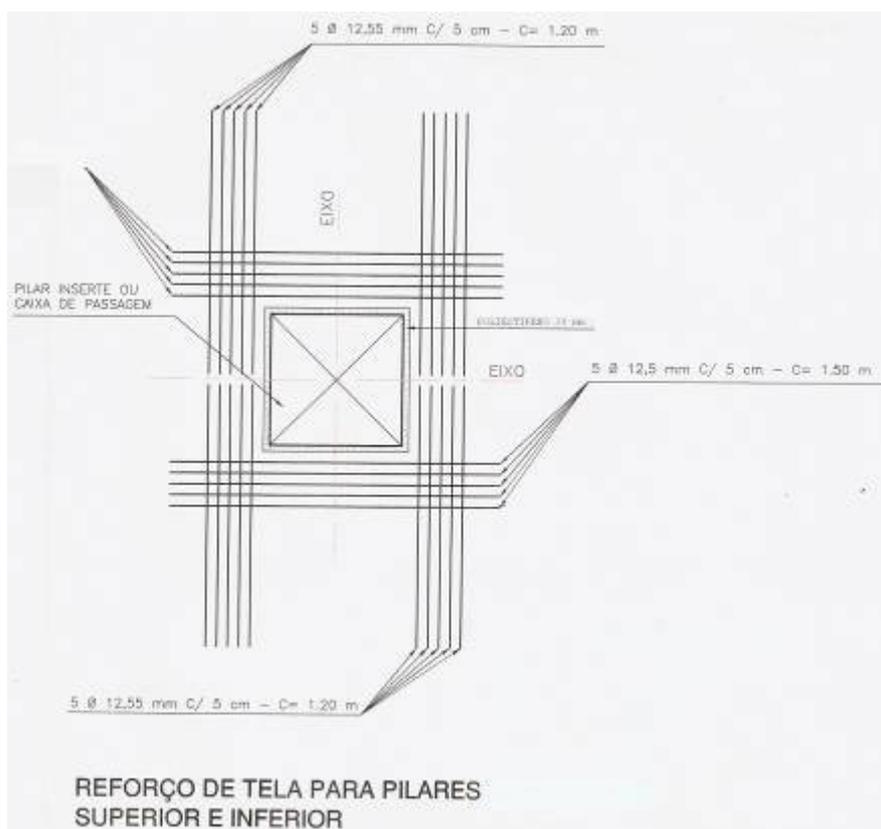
Detalhe de Junta de Encontro com Elemento Estrutural Inserido na Placa (Vista em Planta)
